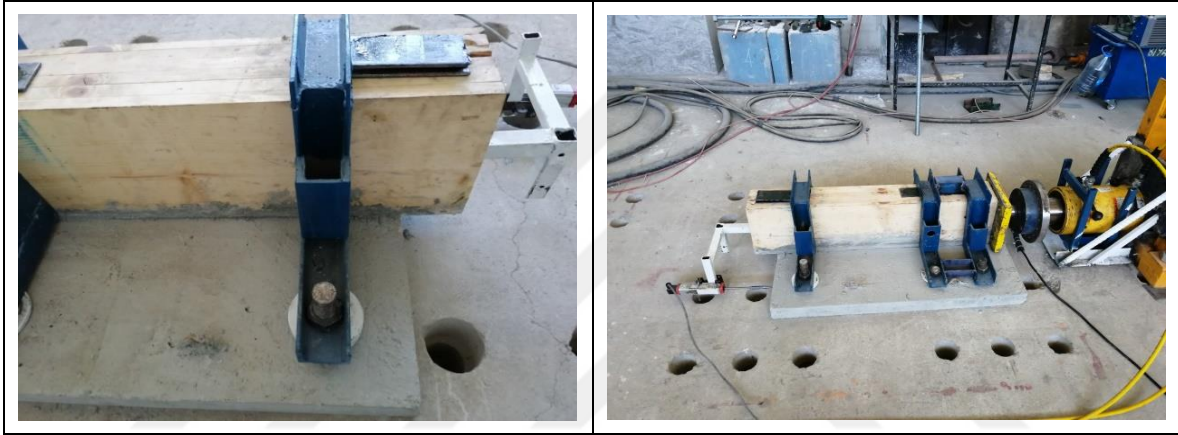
I-2 elemanının deney sırasında bir görünümü.
